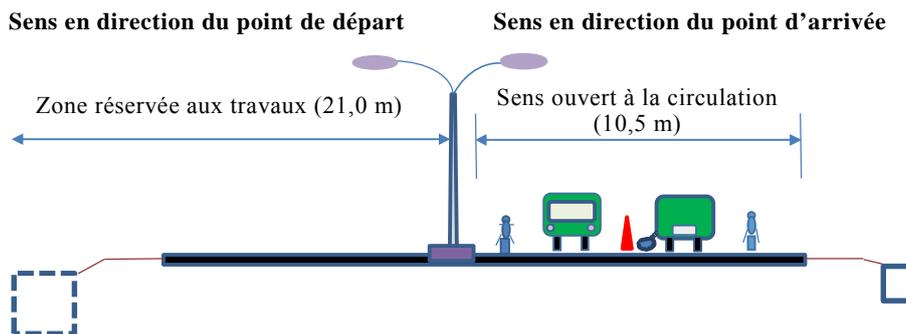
Vue en coupe des conditions de contournement de la circulation sur la route existante (sens en direction du point de départ) (Assujettissement de l'espace pour permettre la circulation sur 2 voies par sens)
